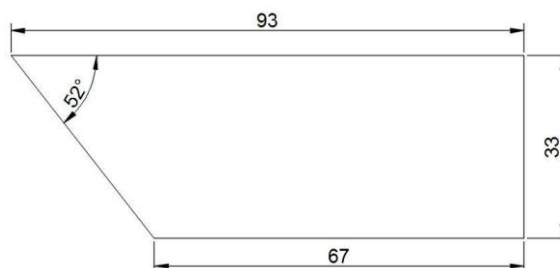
Planta do perímetro da obra a ser escavado (medidas em metros).
